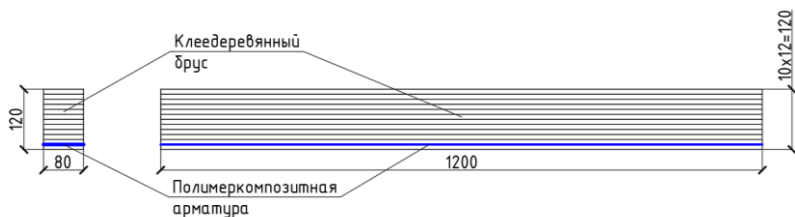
Пример клеедеревянного элемента, армированного полимеркомпозитной арматурой
